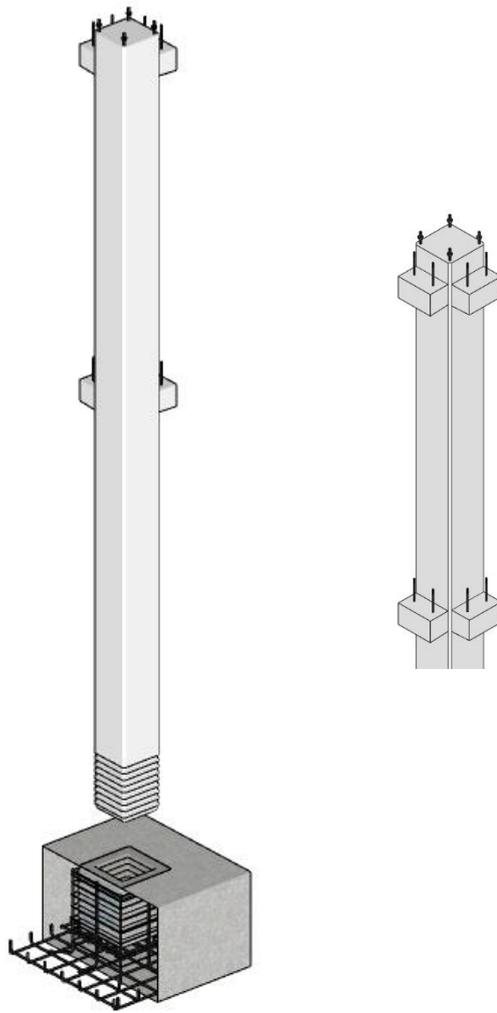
Pilar Prefabricado con unión rígida viga-pilar. Fuente: Jaime Santa Cruz, SketchUp, TEMA (2024).
